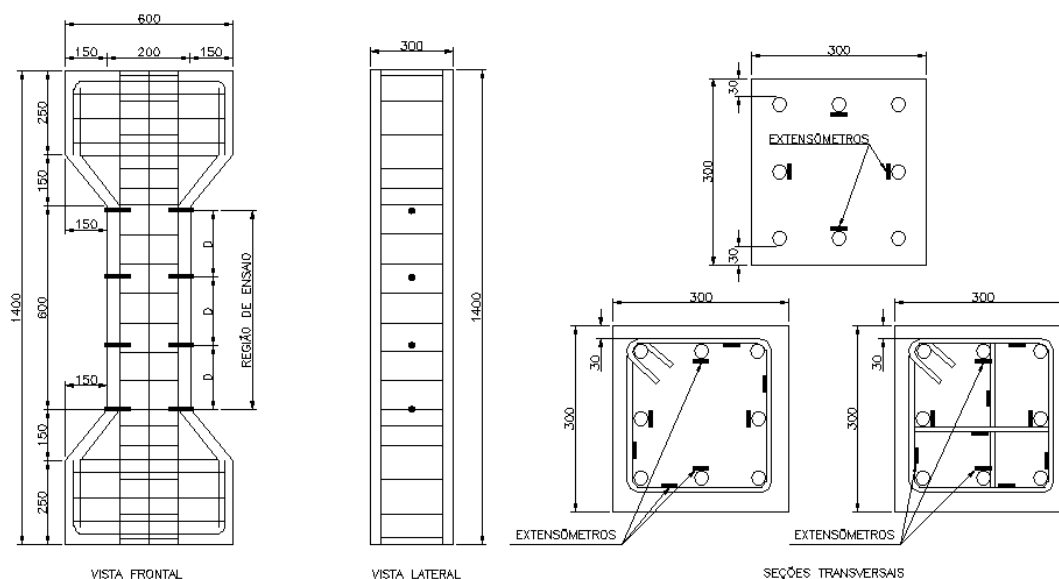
Disposição da armadura e instrumentação das barras – LIN *et al.* (2008)
